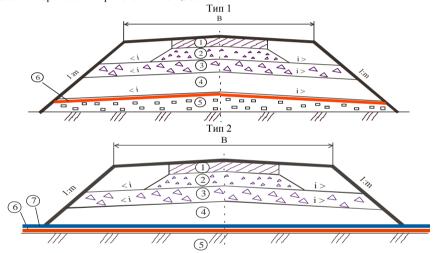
Схема конструкции насыпи с применением геоматериалов: 1 – покрытие; 2 – конструкция основания; 3 – щебень; 4 – дренирующий слой; 5 – переувлажненный грунт; 6 – геосетка или геотекстиль ART; 7 – георешетка, заполненная щебнем или песком
